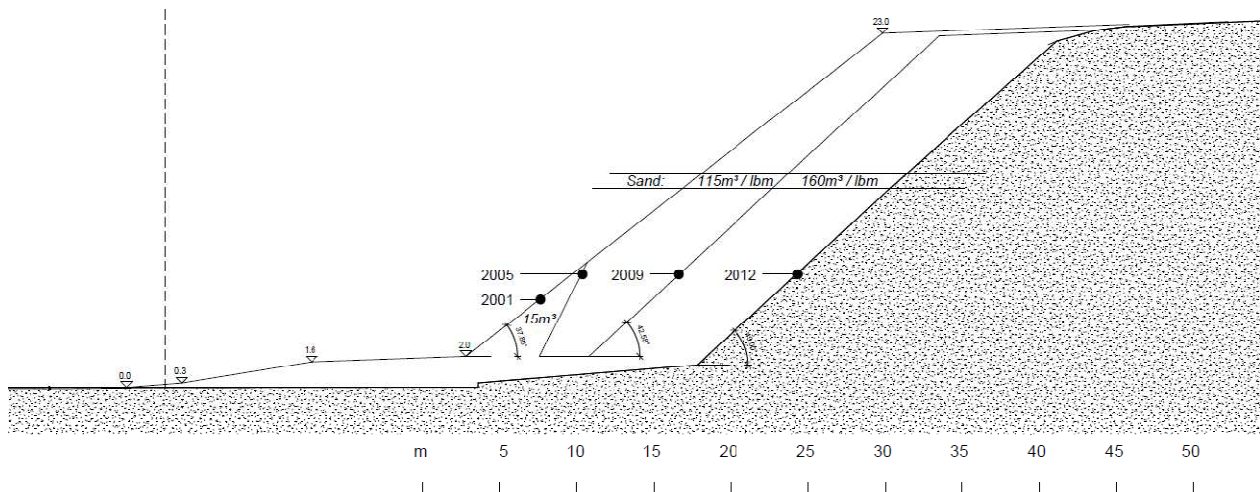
Oversigtsplan for opmåling af kysten og skråningen
